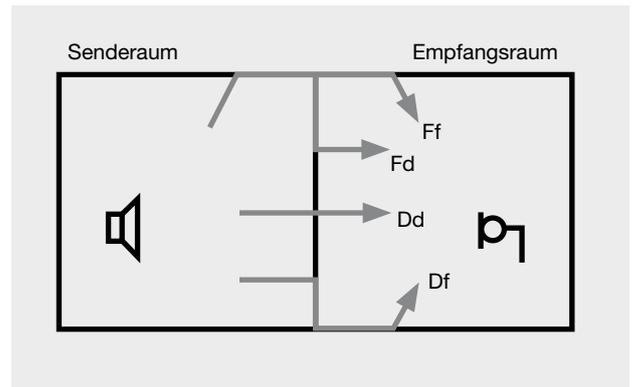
Schallübertragung zwischen dem lauten Senderaum und dem leisen Empfangsraum über das trennende Bauteil und die flankierenden Bauteile
